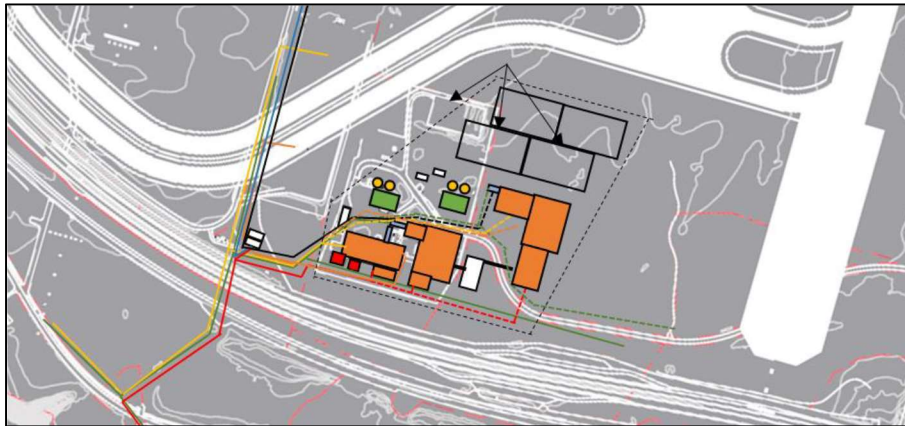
Rød strek planlagt overføringsledning går gjennom planområdet markert med brun ring.
